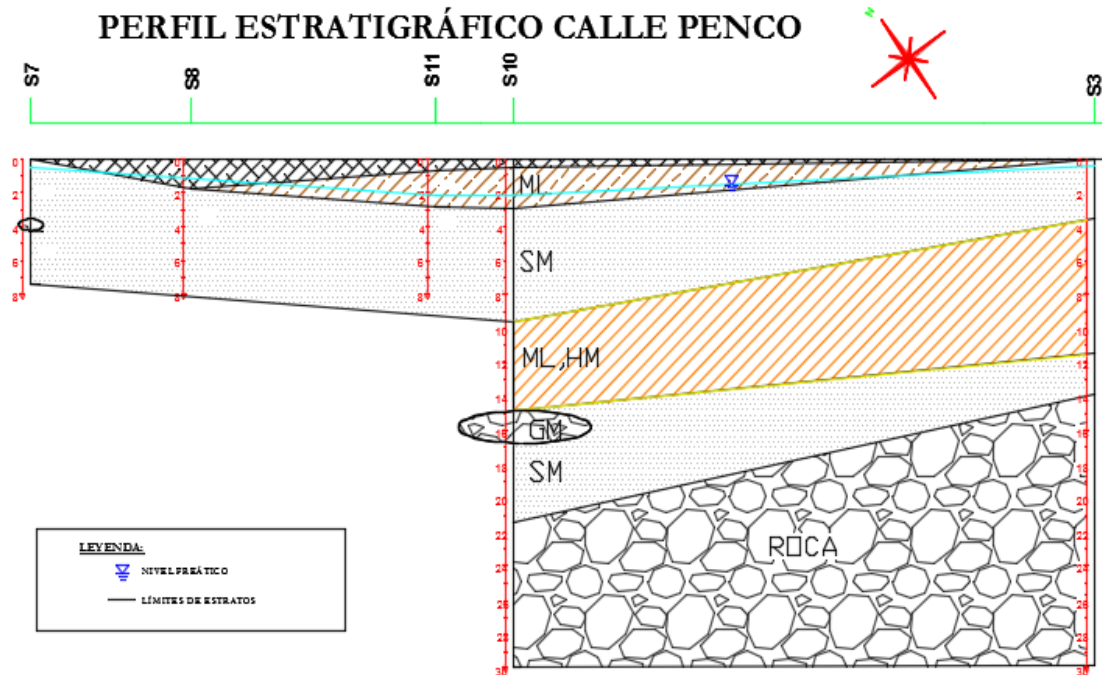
Proyección se sondajes sobre eje con orientación Norte-Sur, por calle Penco.
